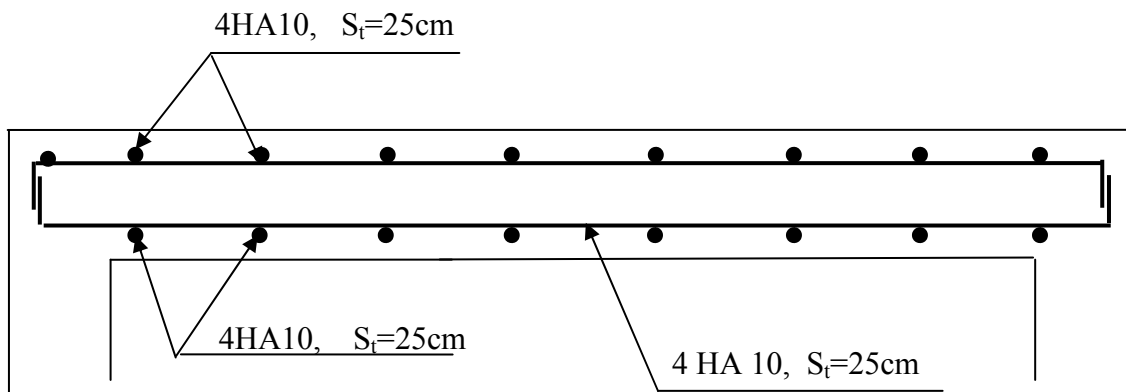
Plan de ferrailage de la salle machine suivant y-y.
